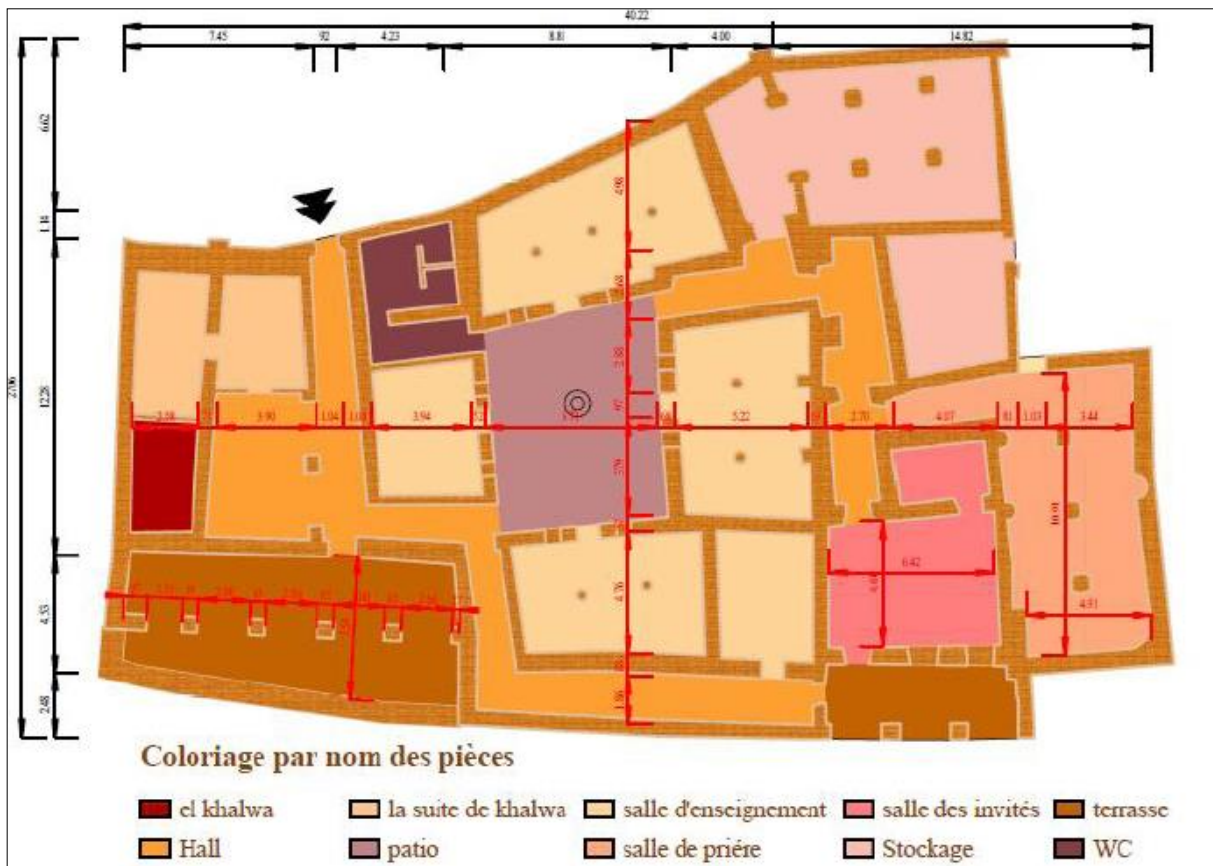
Plan de la Zaouïa du ksar de Boussemgoun
